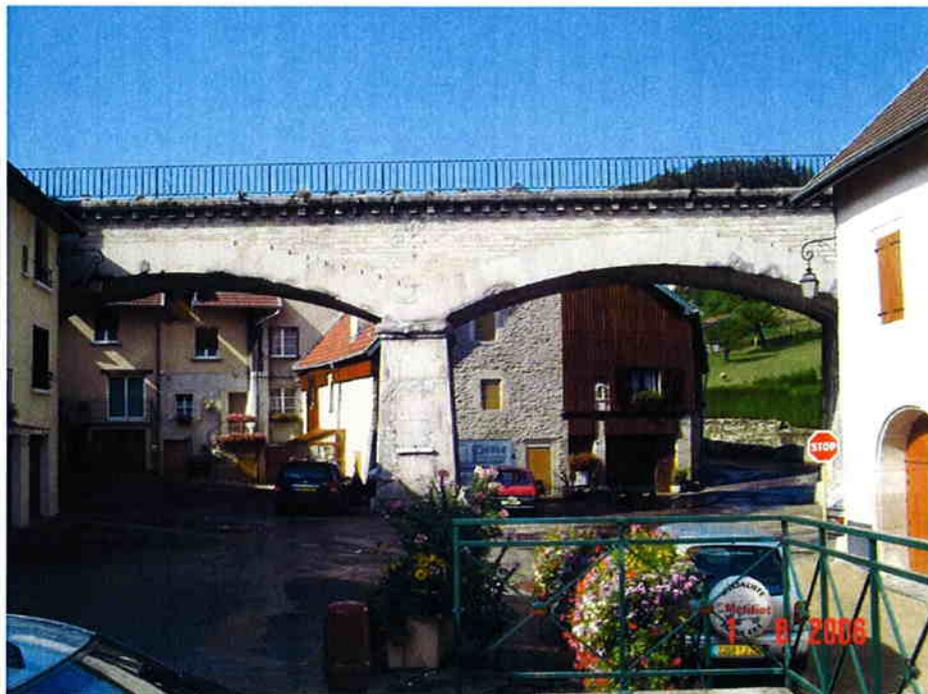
zone 5 (profils 14 à 18) - espaces verts dans le prolongement du viaduc puis rue de la Plante.
